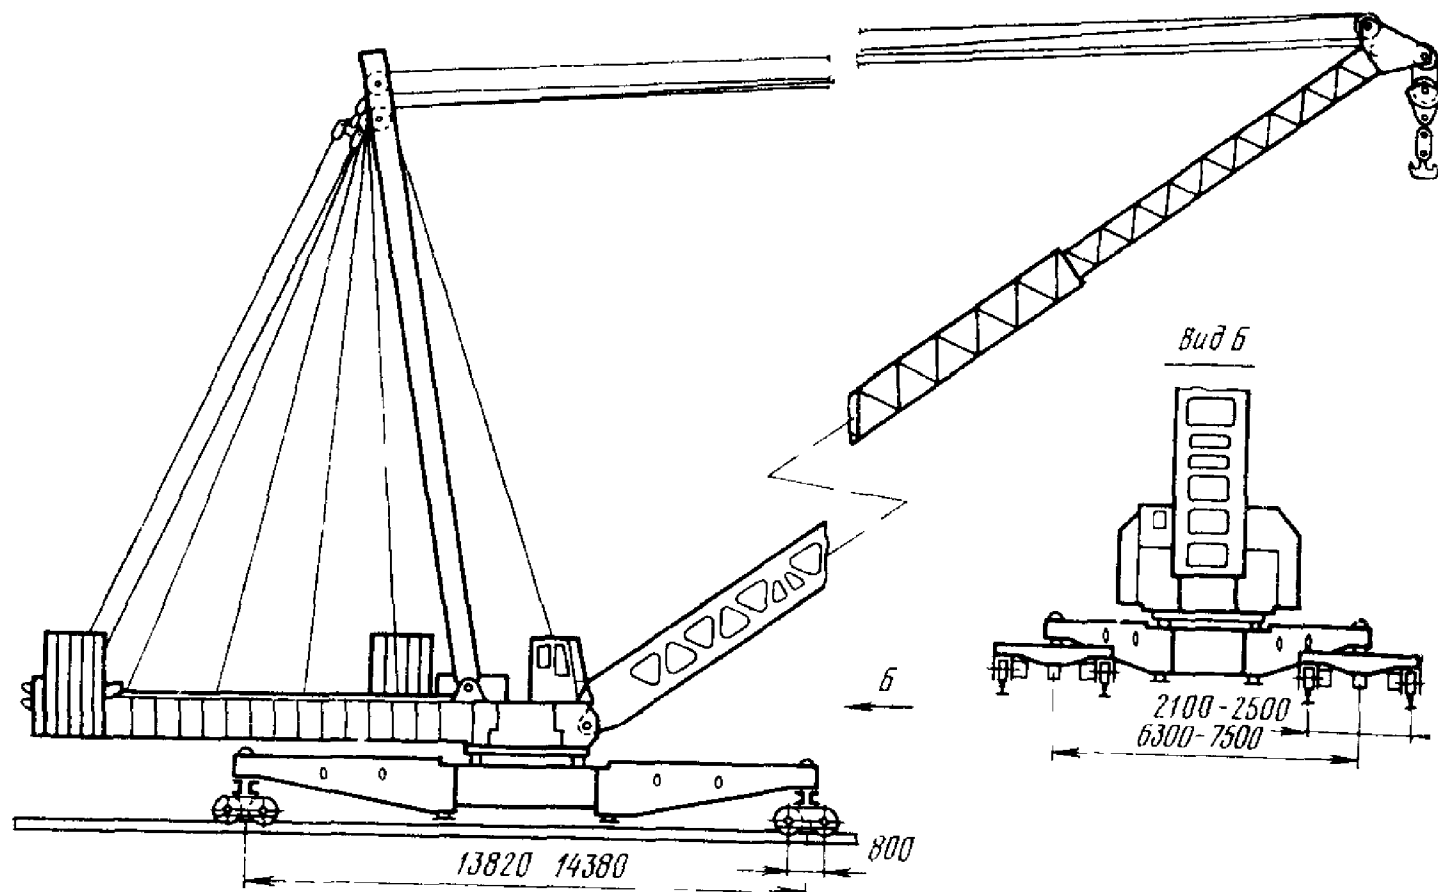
Монтажный кран МК-63 (вариант сборки крана при работе «сверху»)
